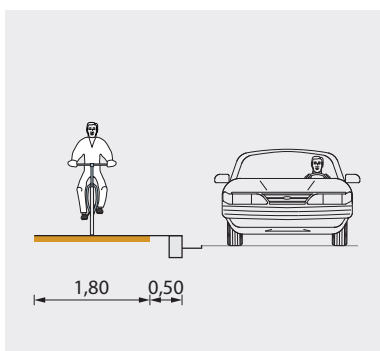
Piste cyclable avec zone tampon par rapport à la chaussée.
